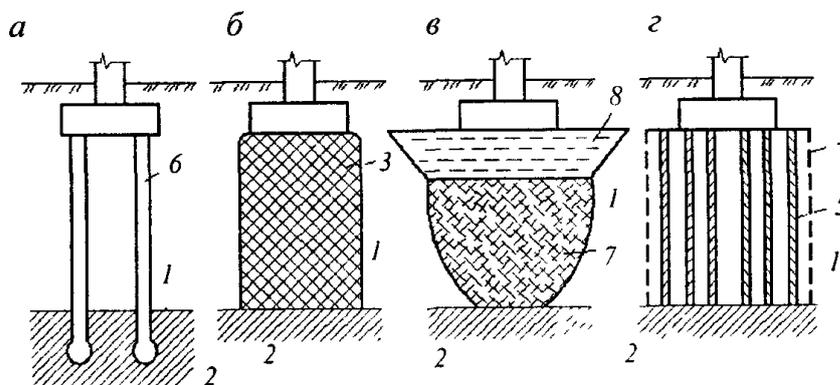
Различные варианты устройства оснований и фундаментов в грунтовых условиях при II типе просадочности: 1 - просадочный грунт; 2 - непросадочный грунт; 3 - закрепленный грунт; 4 - зона уплотнения грунта и грунтовыми сваями; 5 - грунтовые сваи; 6 - сваи; 7 - уплотненный грунт; 8 - грунт, уплотненный тяжелыми трамбовками
